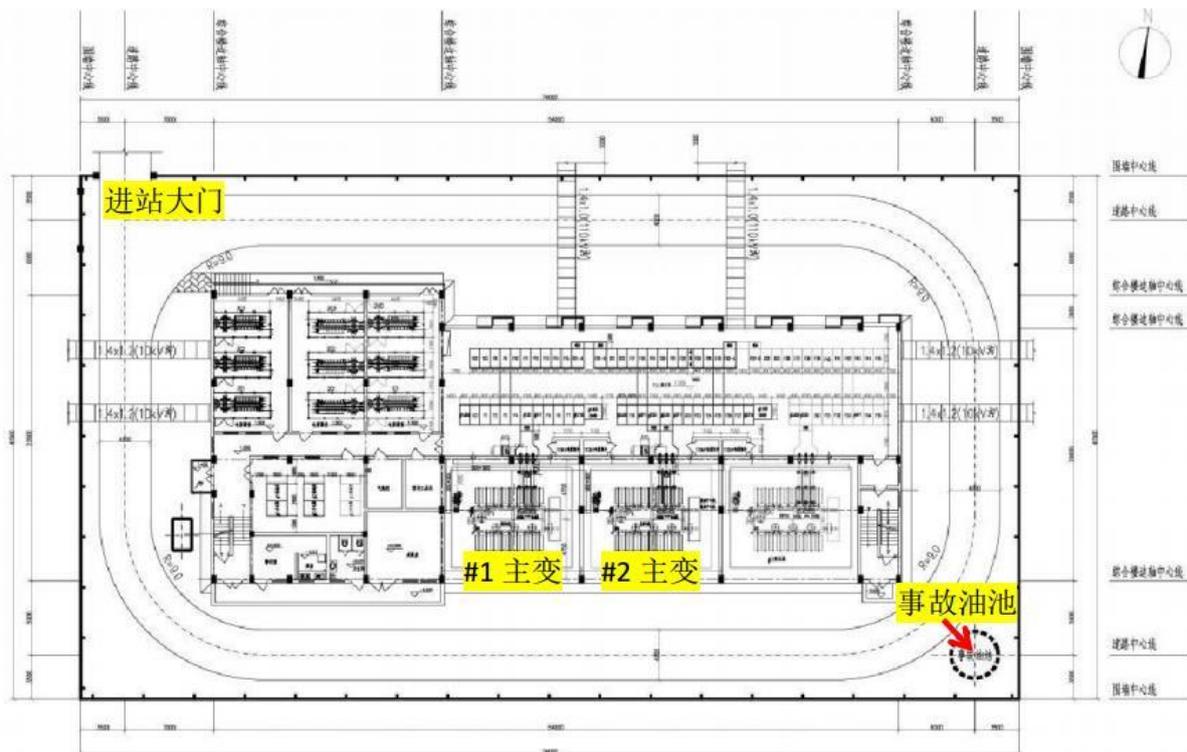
惠州 110 千伏曙光变电站总平面布置示意图
